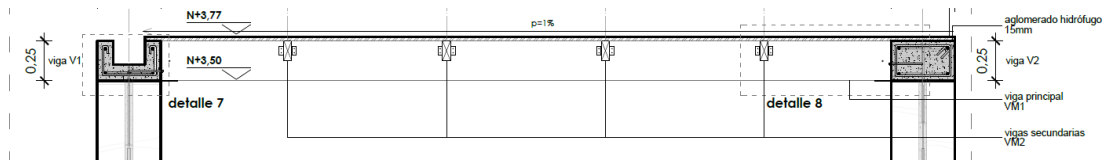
Sección estructural de la cubierta Fuente: Cristian Campaña, 2018
